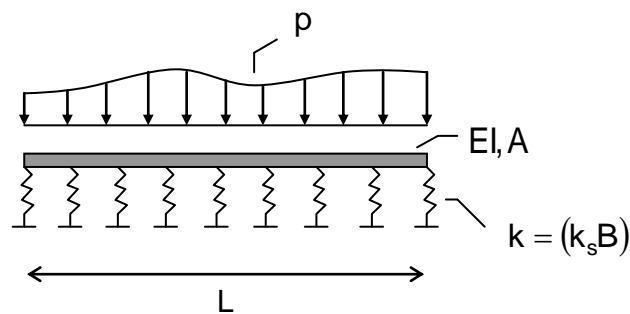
Viga sobre base elástica – MILFONT (1999)
